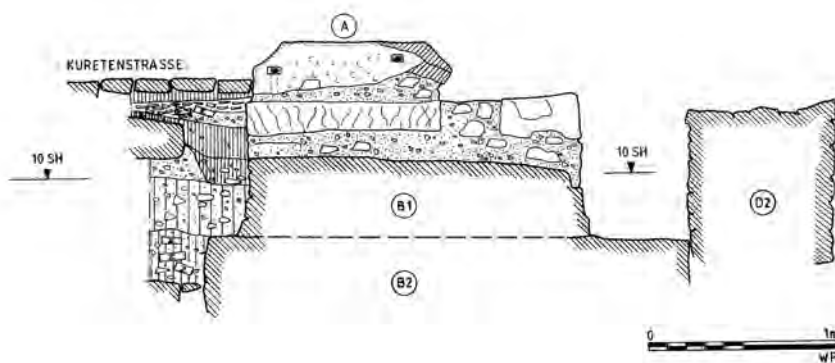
Kuretenhalle, Schnitt über den Südstylobat der Hallenbauten mit Stylobat A
